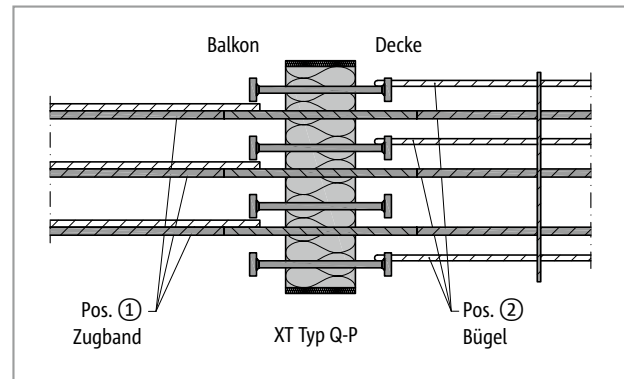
Schöck Isokorb® XT Typ Q-P: Detail 1; Bewehrungsanschluss Zugband
